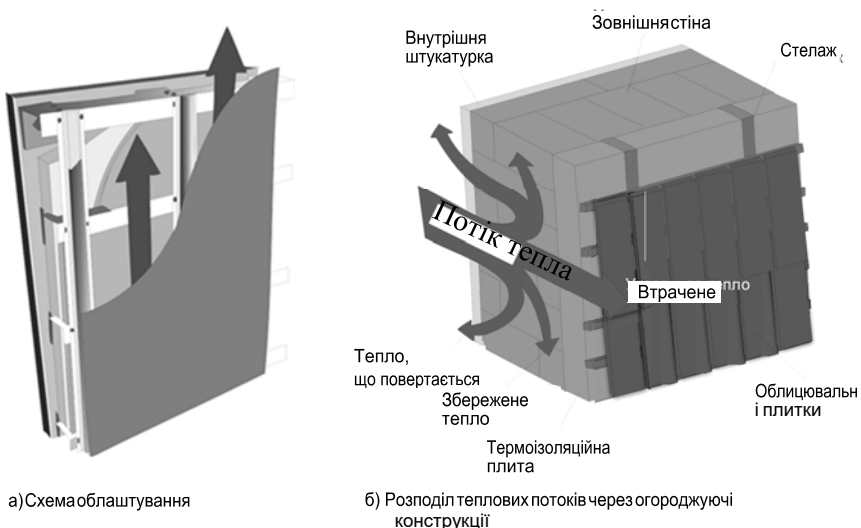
Система теплоізоляції з облаштуванням вентильованих фасадів
